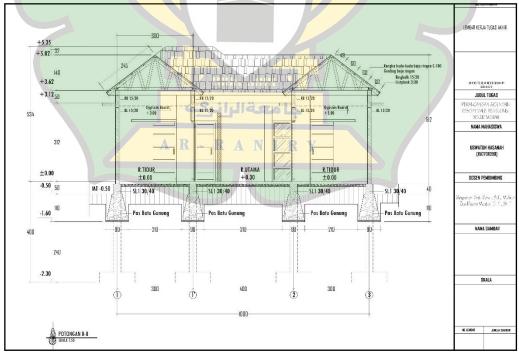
Potongan Bangunan Utama Sumber : Rancangan Pribadi
